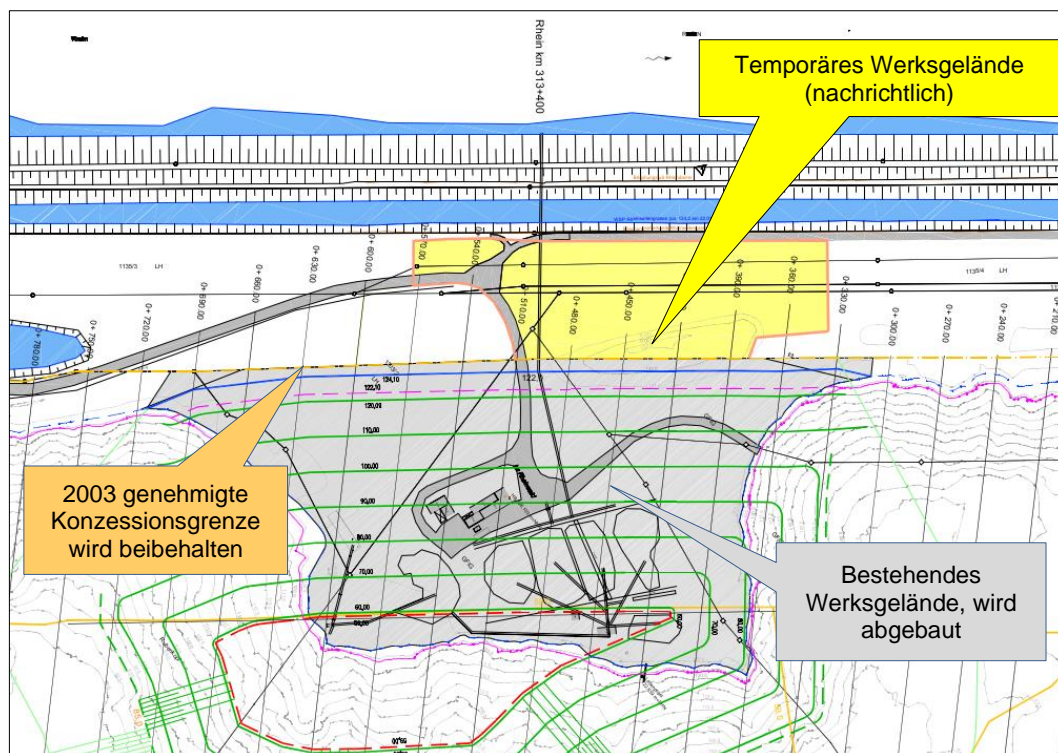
Lageplan des bestehenden Werksgeländes (Abbaubereich) (WALD + CORBE 2022).
